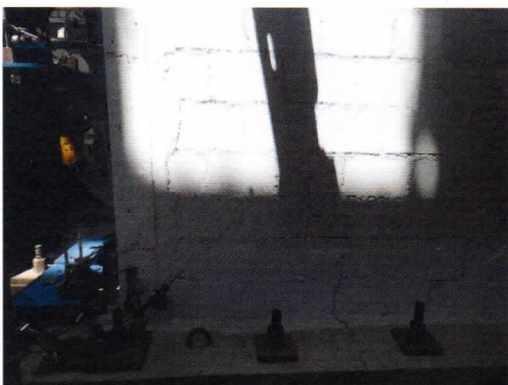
Continuación de grietas diagonales en el mortero en la parte inferior Este de la cara Norte para una distorsión de 1/1100.
